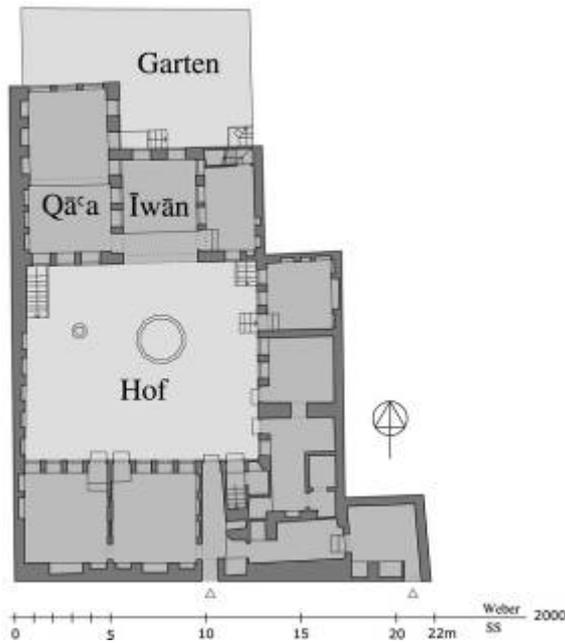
Bayt 'Ağamī, Grundriss EG
